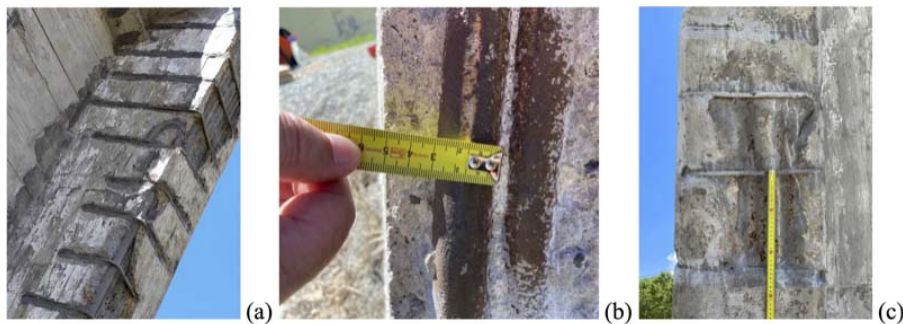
Zona di ripresa dell'armatura (a); diametro delle barre (b); passo delle staffe (c).
